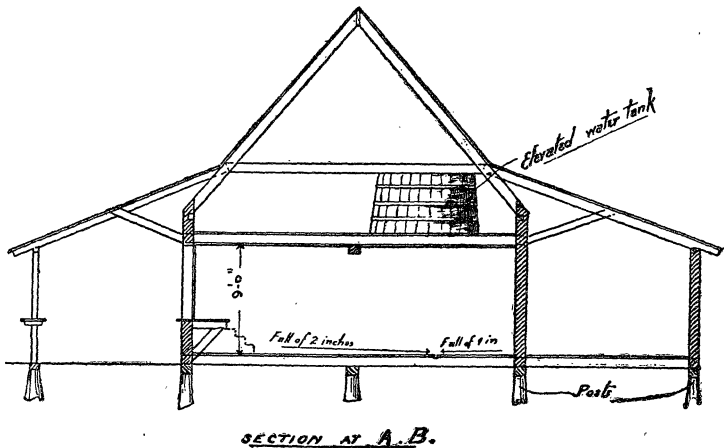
FIGURE I.—Indiquant une section de la Figure II à A, B, à travers le chemin couvert, la salle de fabrication et les chambres de la chaudière et de la machine.
